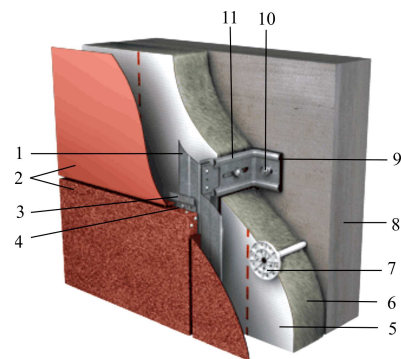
Схема устройства фасадов с облицовкой натуральным полированным гранитом
